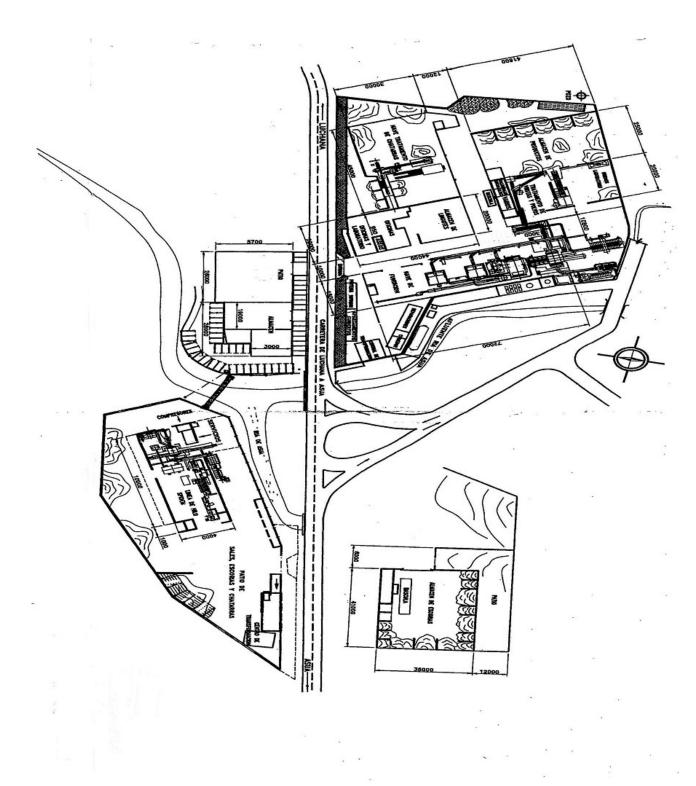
Plano de las instalaciones de la planta de Erandio.
